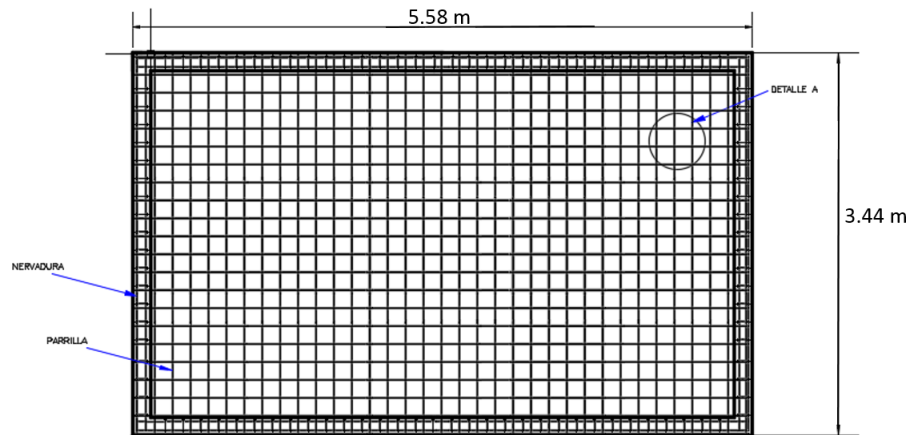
Armadura de la losa de concreto para la ubicación de los equipos principales.
